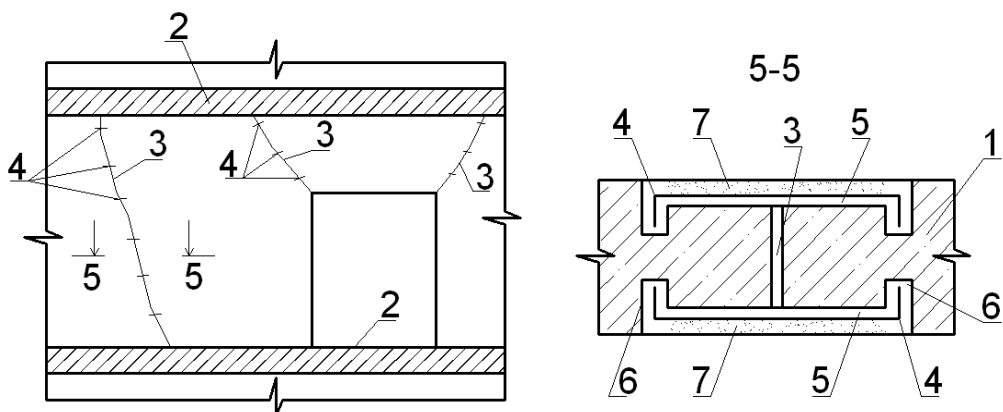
Встановлення накладок з арматури: 1 – посилювана панель; 2 – міжповерхові перекриття; 3 – наскрізні тріщини в стіні шириною до 10 мм; 4 – П-подібні накладки з арматурної сталі; 5 – пази в захисному шарі бетону; 6 – отвори по кінцях пазів, виконані свердлом; 7 – пази й отвори,
